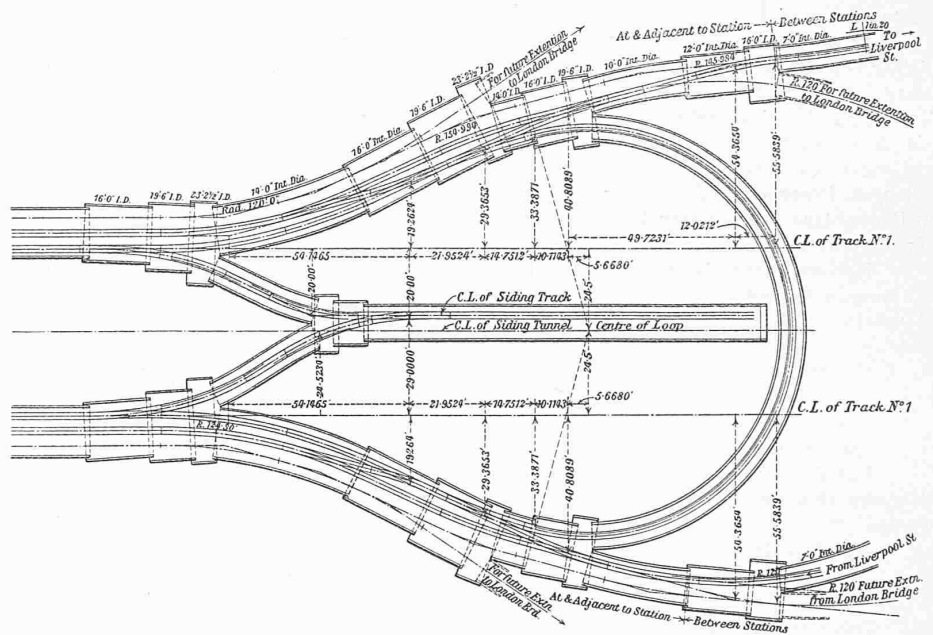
Lageplan eines Stationendes mit Schleife, Abstellgeleise, Abzweigungen. — 1 : 600. (Nach „Engineering“).
